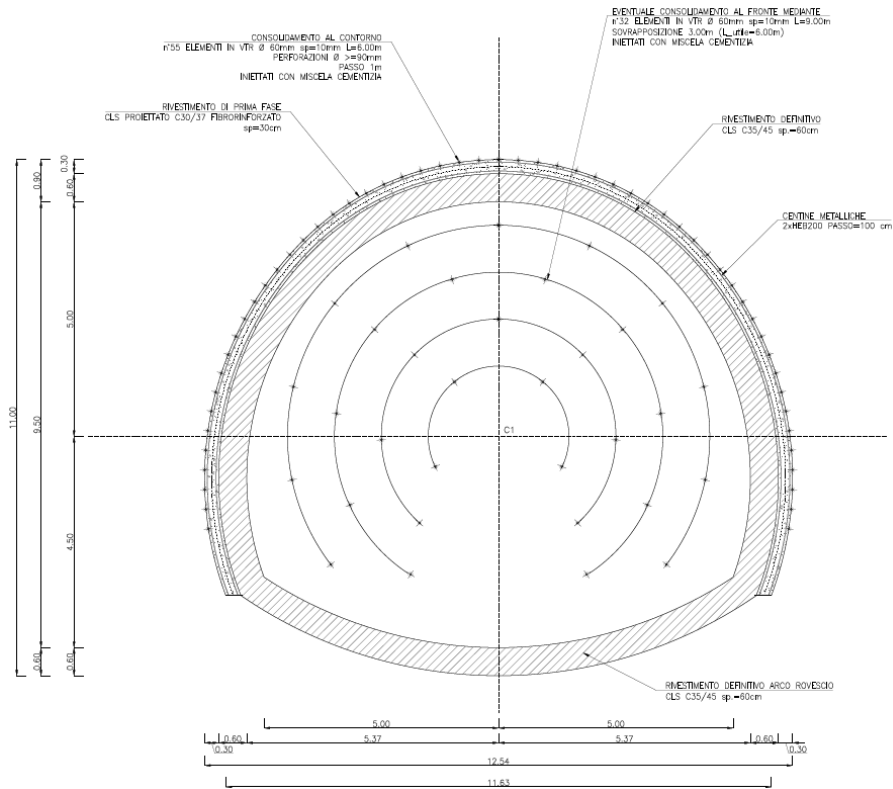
Sezione tipo D4: geometria del cavo e interventi di sostegno, sezione trasversale
